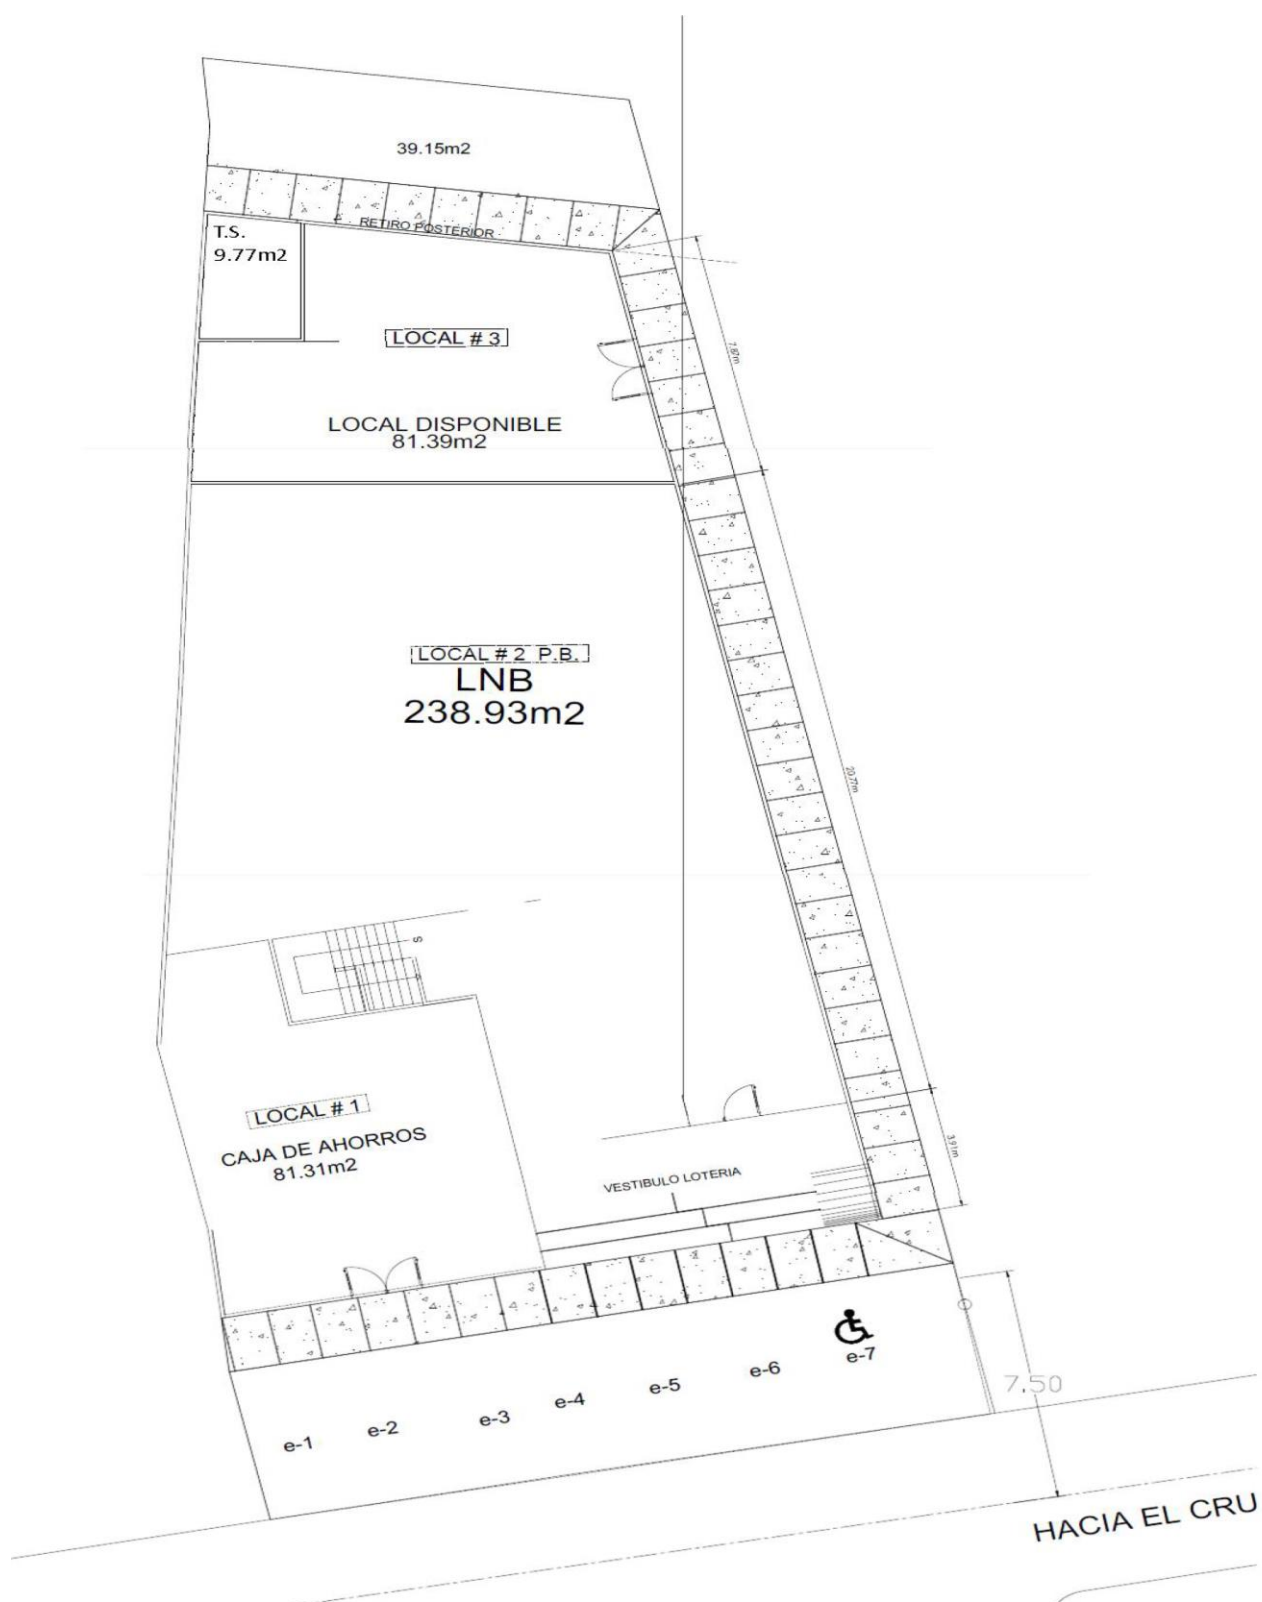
Vista general de la Planta Arquitectónica de la Planta Baja.
